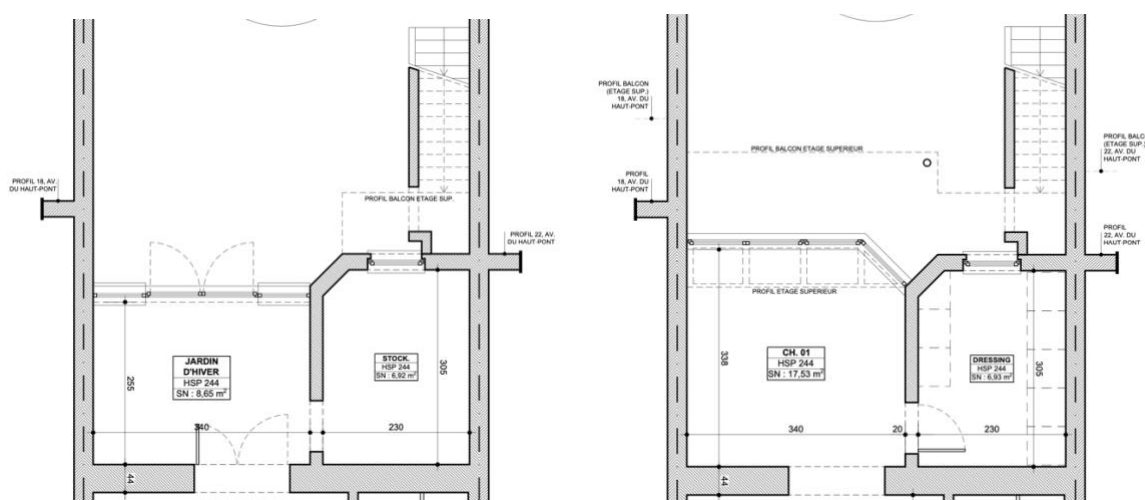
Extension de la surface du jardin d'hiver (à gauche) grâce au remplacement du châssis droit existant par une verrière (à droite). Il est à relever que l'extension ne dépasse pas les gabarits voisins de gauche, dont l'amorce apparaît sur les plans.
